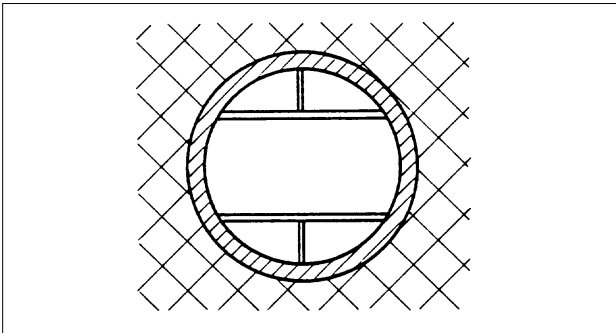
Bergmännisch erstellte Tunnels für den Strassen- und Eisenbahnverkehr:
